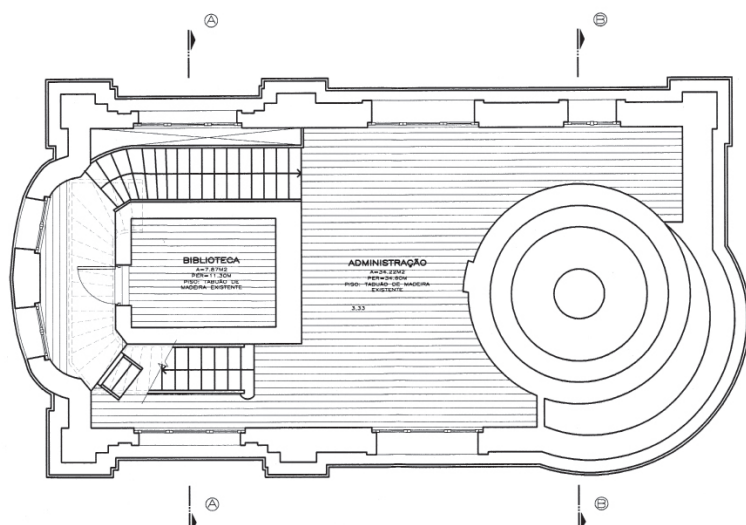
A planta baixa do primeiro pavimento ilustra a circulação pelas escadas em torno das paredes da torre da luneta meridiana. A entrada principal fica à esquerda, na fachada Oeste. Acervo do OA/UFRGS
